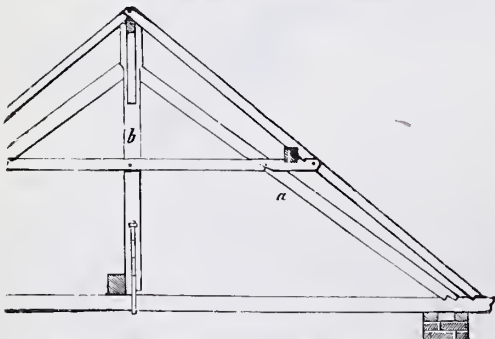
Dach mit einäuligem Hängewerk, für Kehlbalcken.
